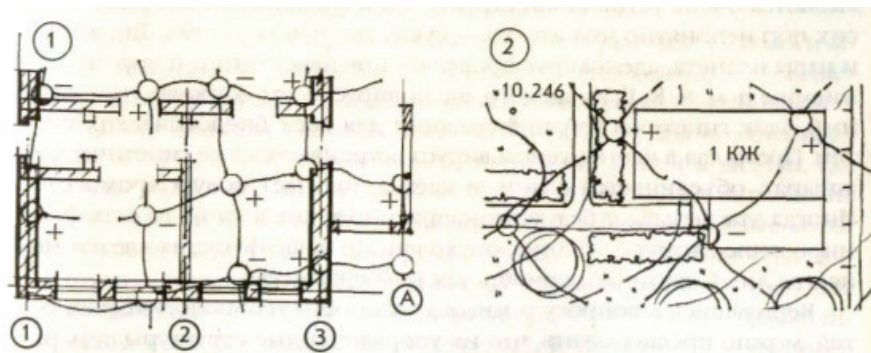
Проявление энерго каркаса Земли в виде геобиологических сетей на строительных чертежах: 1 – план жилого дома, 2 – генеральный план застройки. Кругами изображены узлы (места пересечения каналов) мест активного проявления земной энергетики. Знаками «+» и «-» обозначена направленность излучения относительно земной поверхности (нисходящее и восходящее излучение) [16. С. 37].
